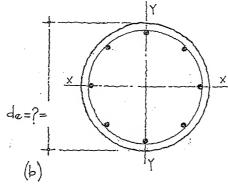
Columno zunchoda visto en plan 2 to, (b). de=?=
